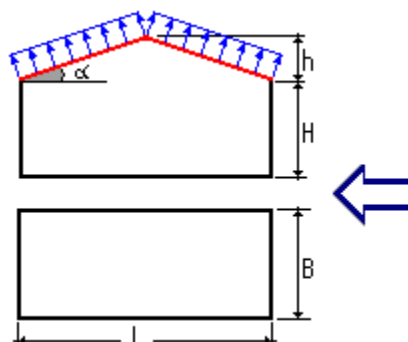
Расчетная схема определения ветровой нагрузки на кровлю
